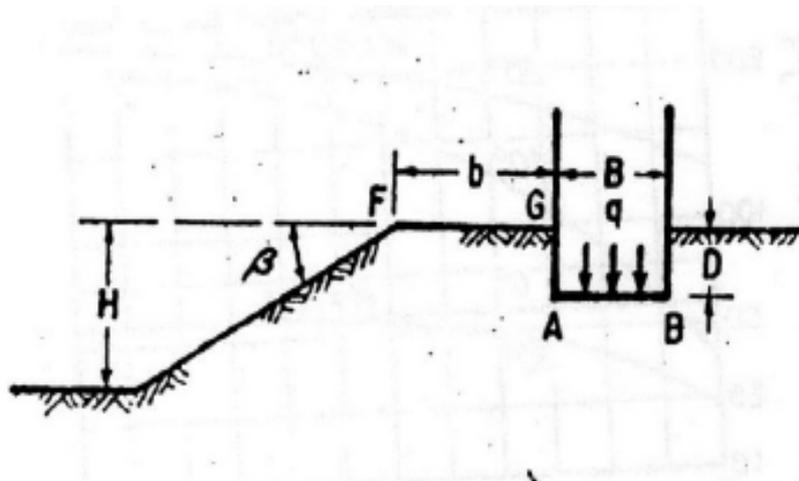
Dimensiones Relevantes para el Cálculo de la Capacidad de Soporte en la Cresta del Talud
